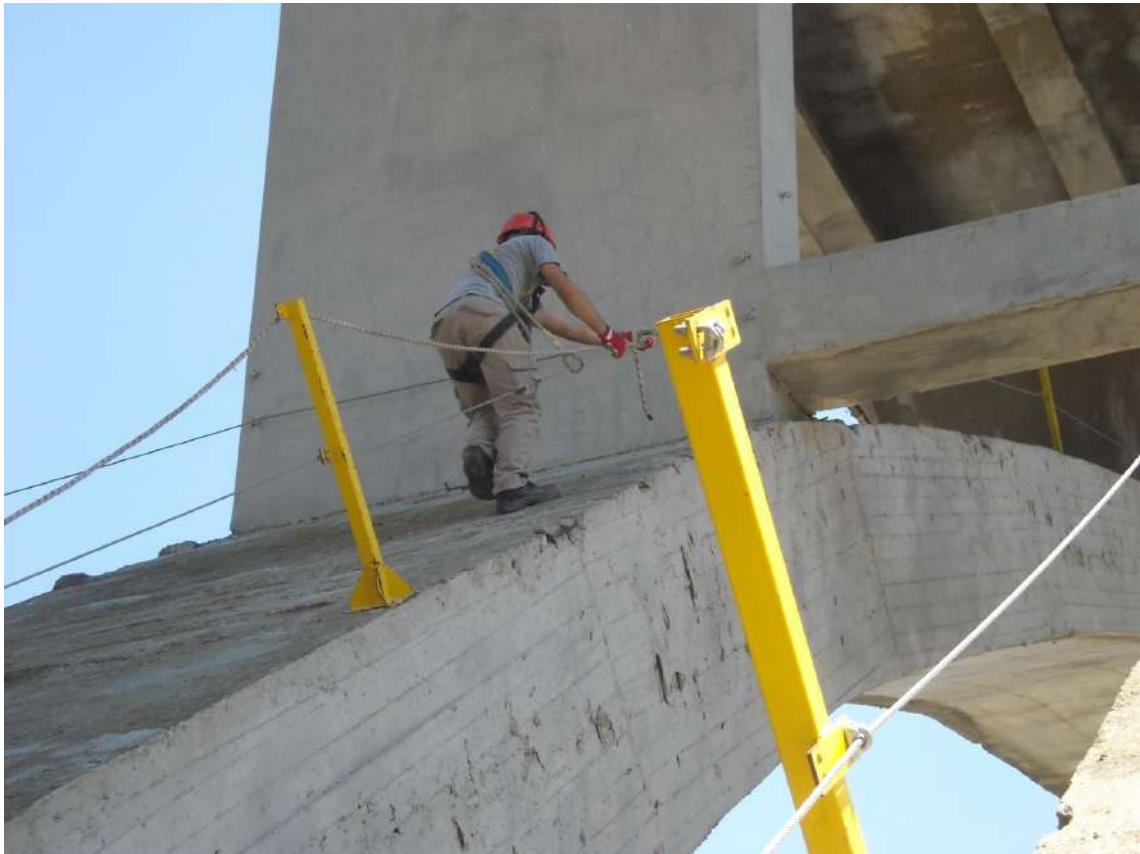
Linee di vita (es. sull'arco), anche con funzione di parapetto. Accesso sull'arco facilitato da scale realizzate con traversi di legno fissati a cavo d'acciaio (facilmente removibili prima dello sparo del ponte).
